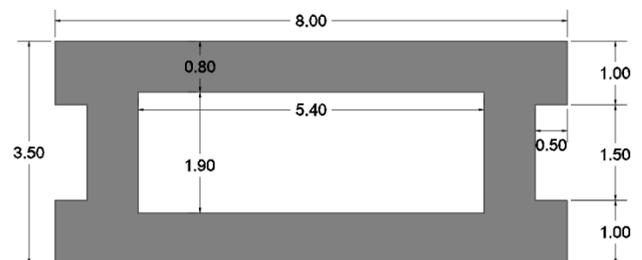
Nuova Pila P7N – Sezz. in elevazione longitudinale e trasversale
